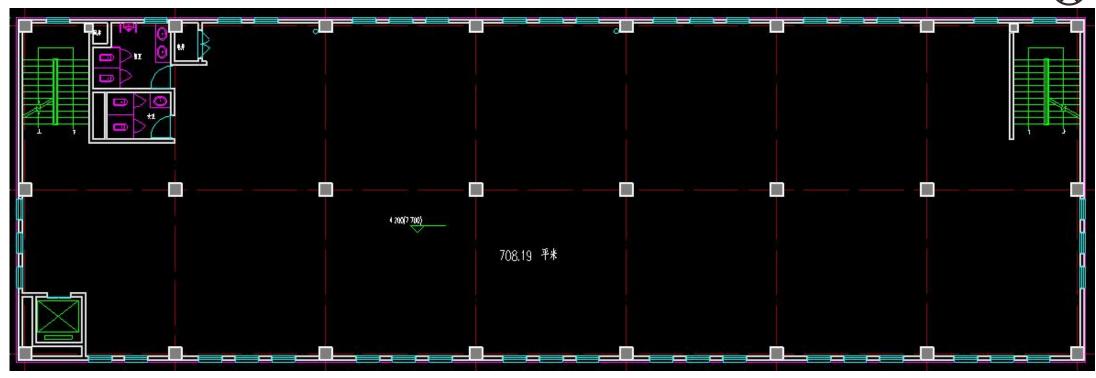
3#楼 2、3 层平面布置图(1: 100)
